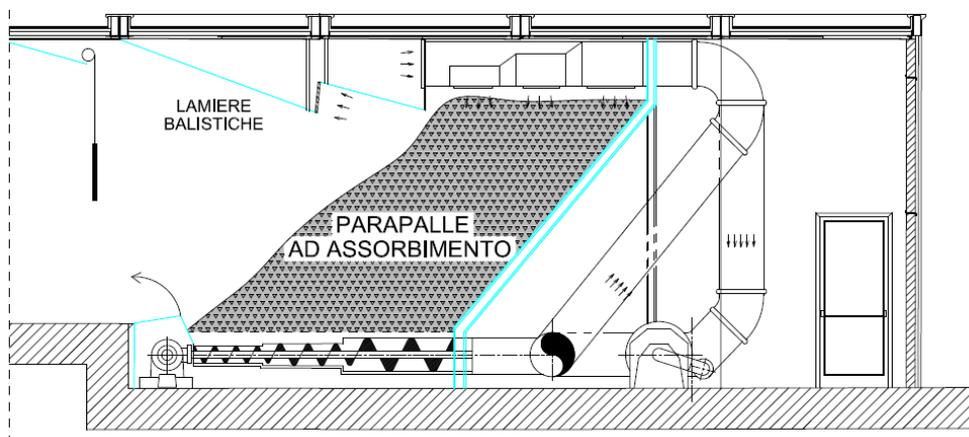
Sezione semplificata di un parapalle ad assorbimento
